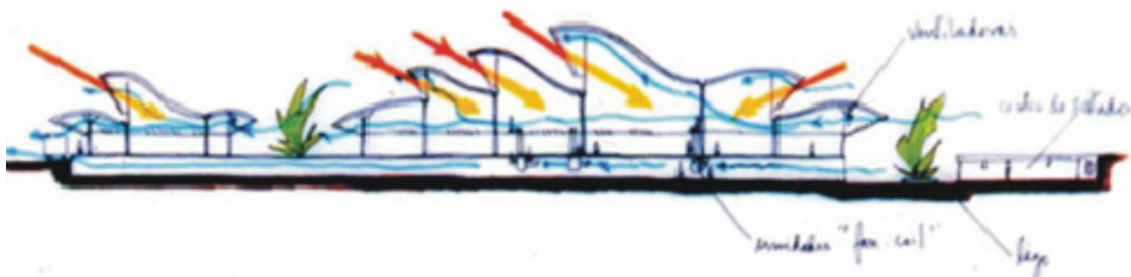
CROQUI COM CORTE ESQUEMÁTICO DO HOSPITAL DA REDE SARAH NO RIO DE JANEIRO
